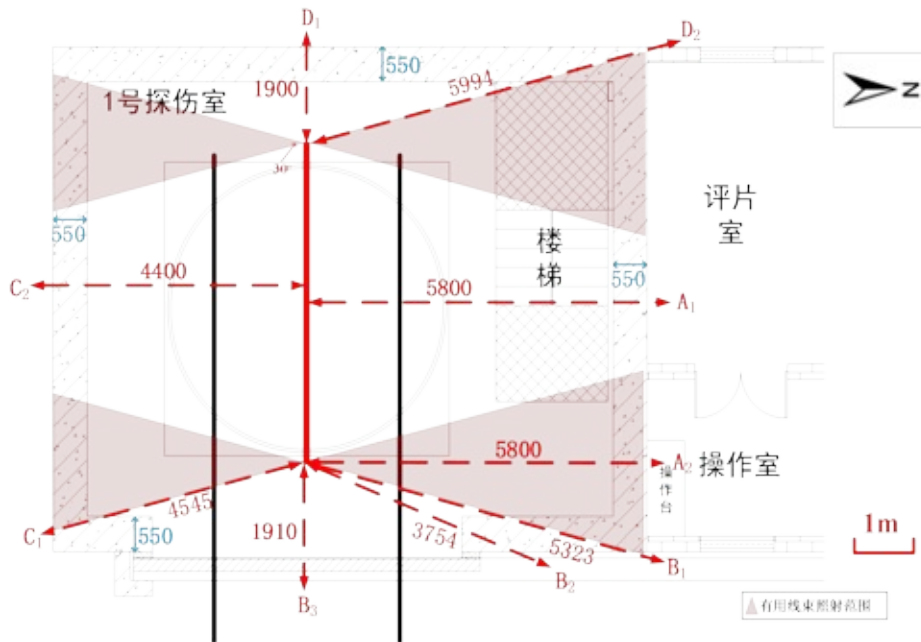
周向探伤机关注点位示意图（平面图，单位：mm）
